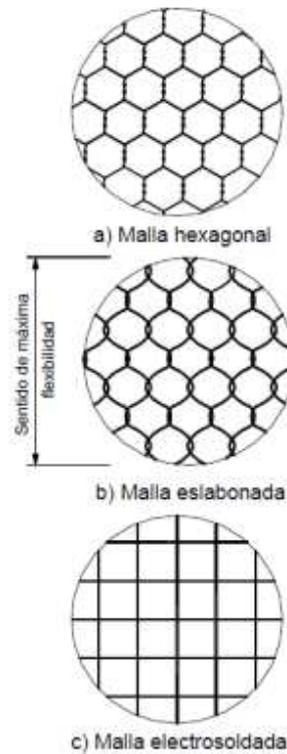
Tipos de mallas utilizadas en la construcción de gaviones. Fuente: (Suárez Díaz, 2001).
